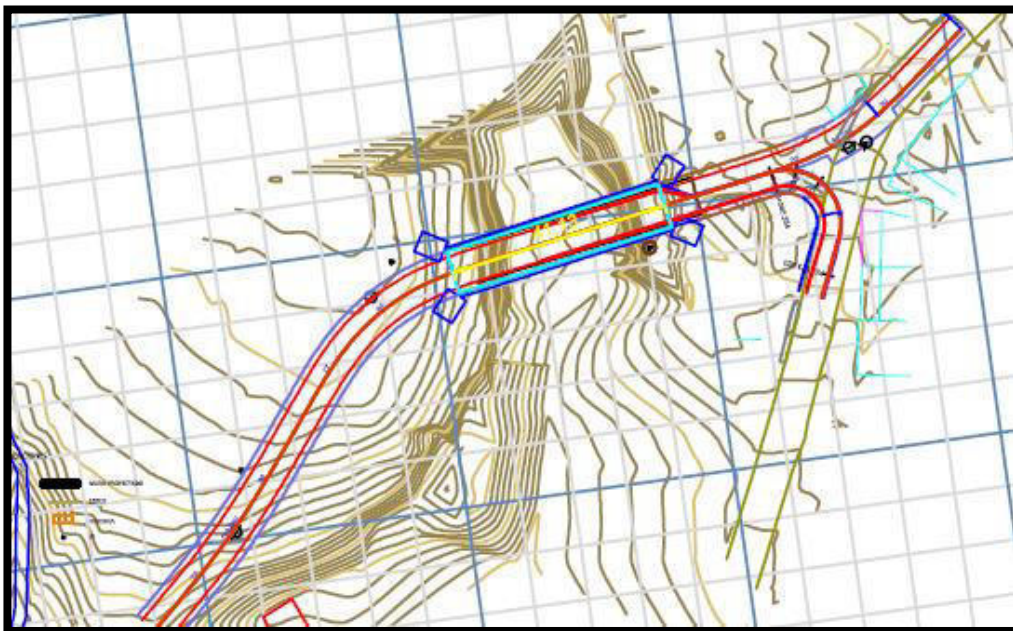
"plano en planta del proyecto puente vehicula Sangoyaco"
